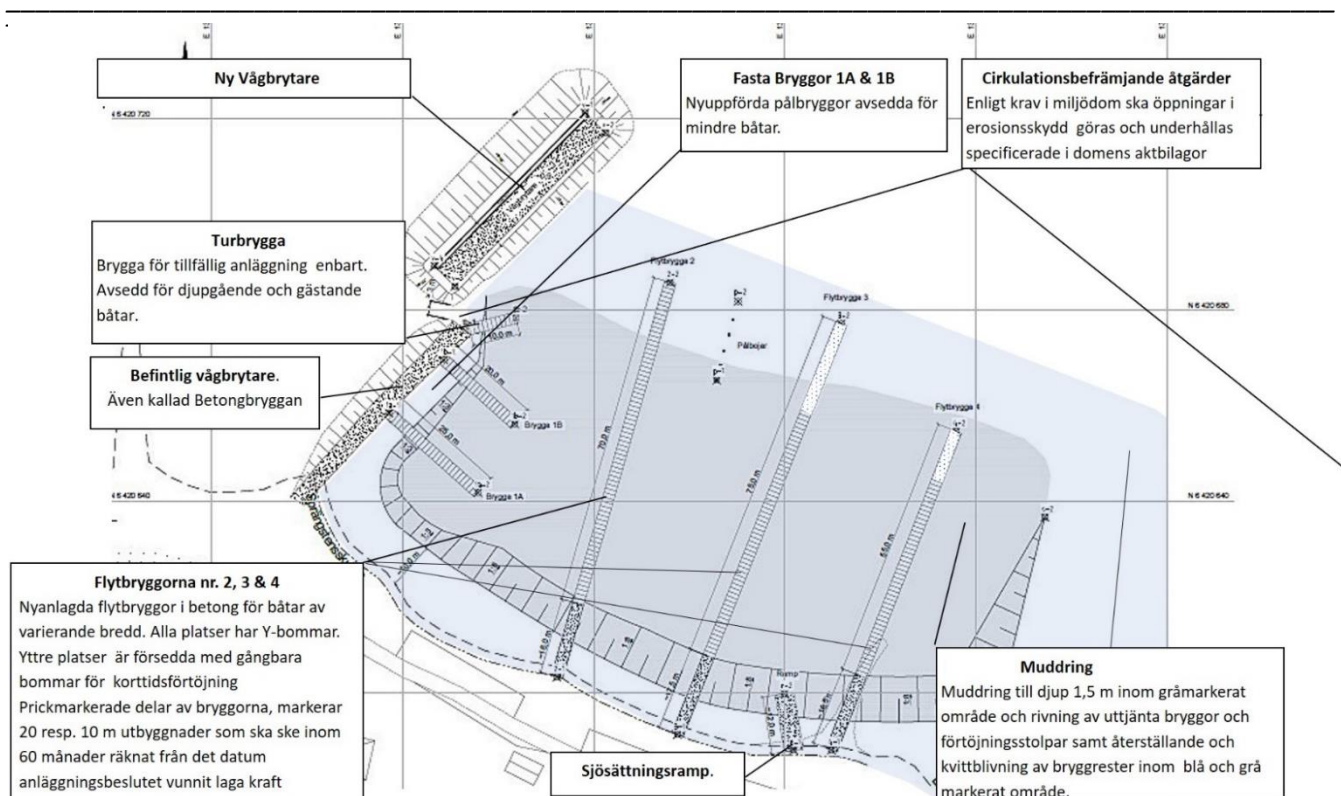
Upprustad hamn. Utformningen och placeringen av de fasta bryggorna närmast Betongbryggan kan variera över tid.
